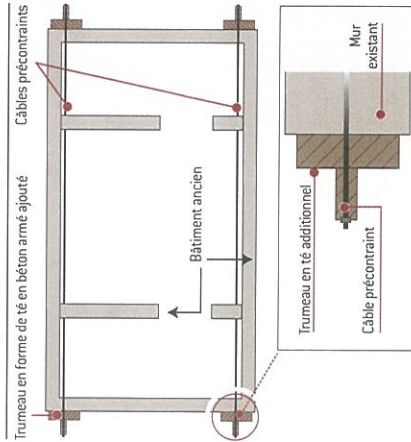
Exemple de renforcement par ajout de murs en béton à l'extérieur + serrage par précontraint (vue en plan)
